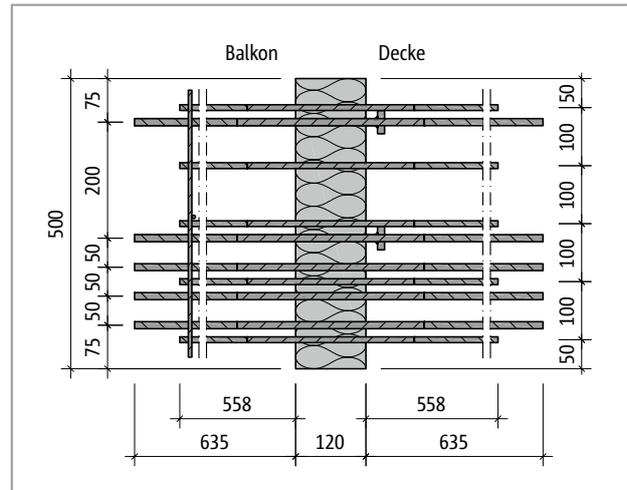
Schöck Isokorb® XT Typ C-R-M1-V1: Produktgrundriss
